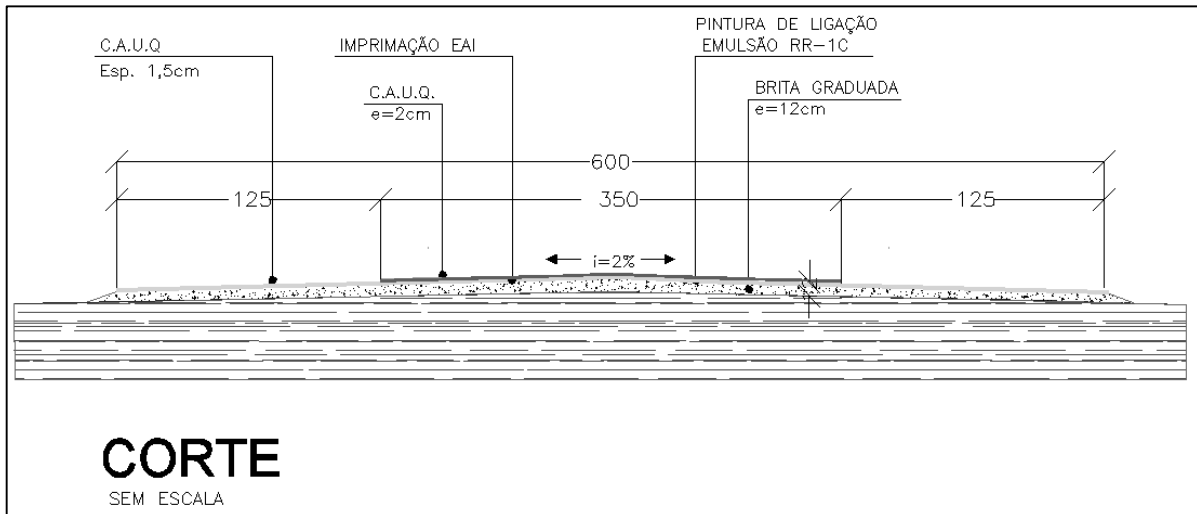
(C) – Seção do Pavimento utilizada em 2017.
